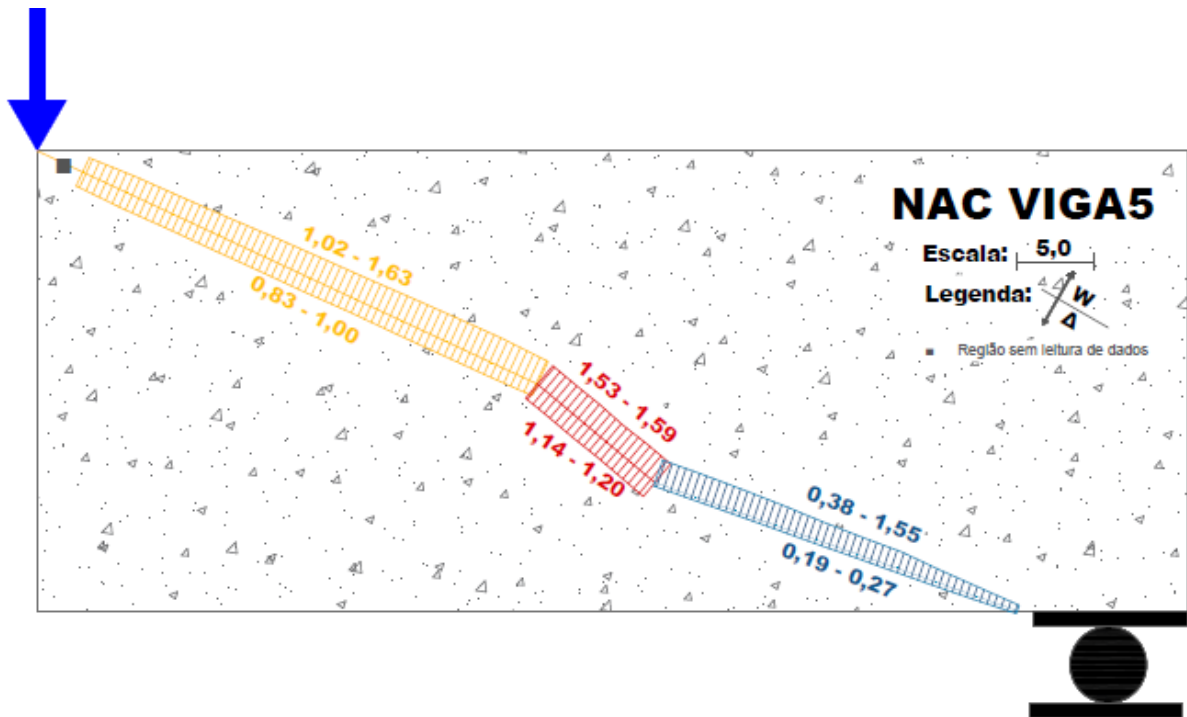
Abertura (w) e deslizamento (Δ) da fissura diagonal crítica da viga NAC-5.
